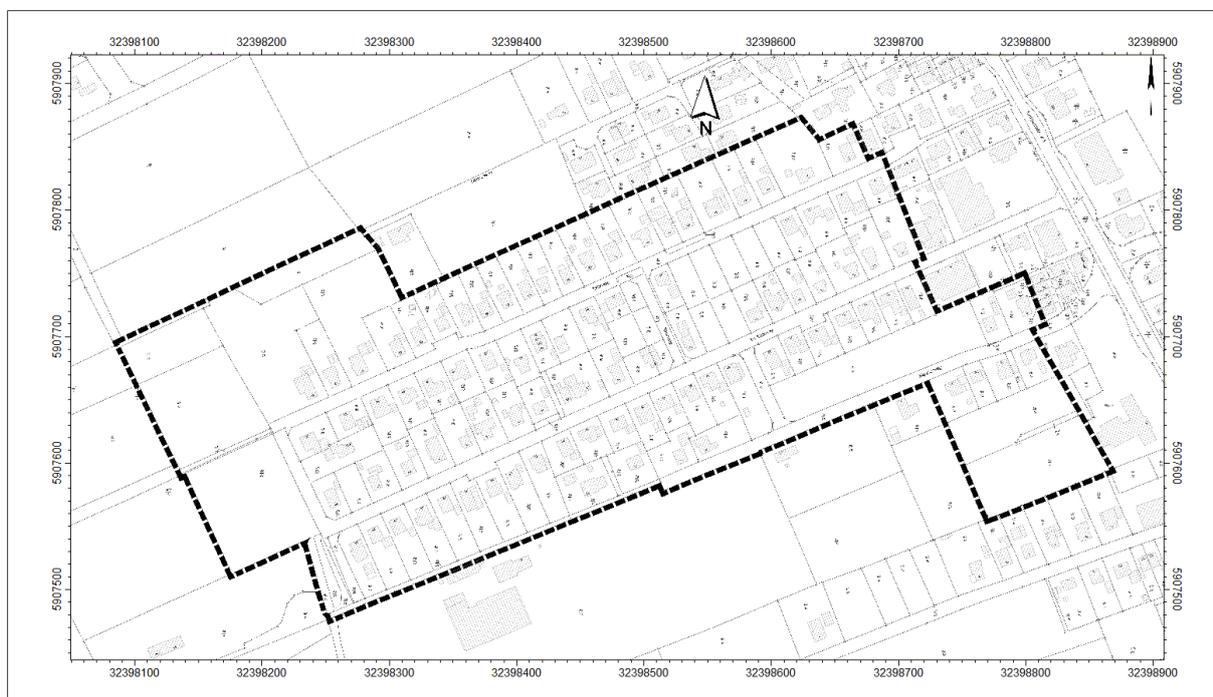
Planzeichnung mit dem Geltungsbereich des B-Plans Nr. N 41, Quelle: /18/.
